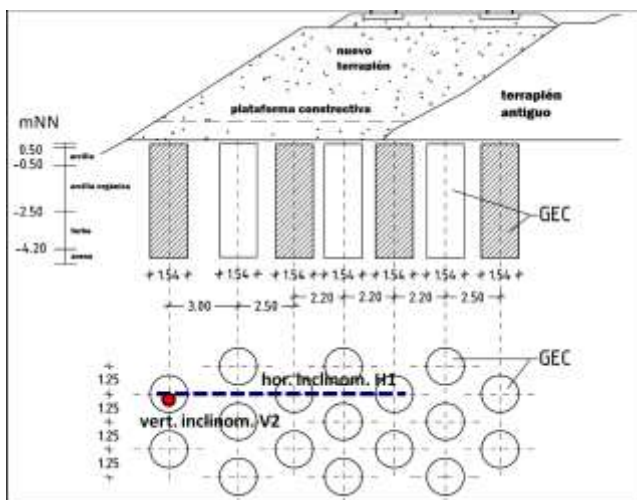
Esquema típico del terraplén ferroviario sobre Columnas GECs en Waltersshof.
